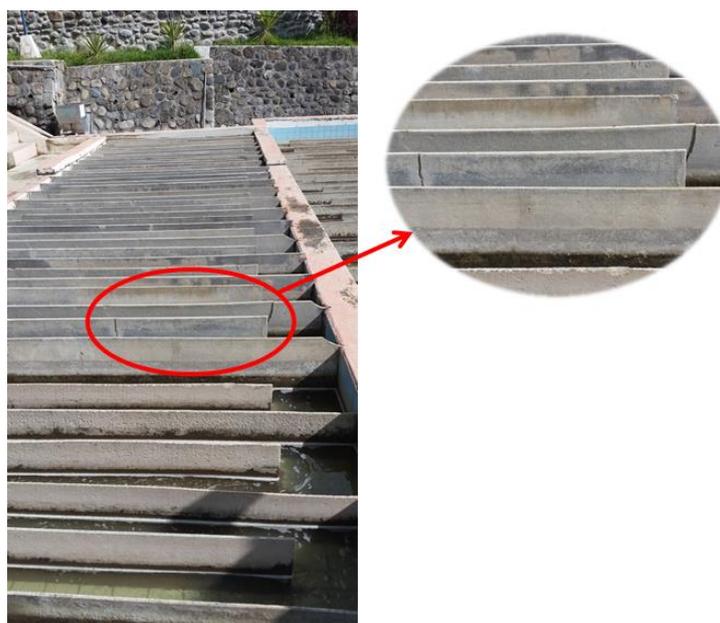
Pantallas del floculador presentan fisuras.
